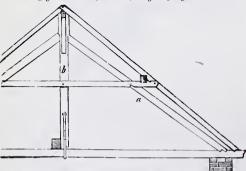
Dach mit einfänligem Sängewert, für Reblbalten.
